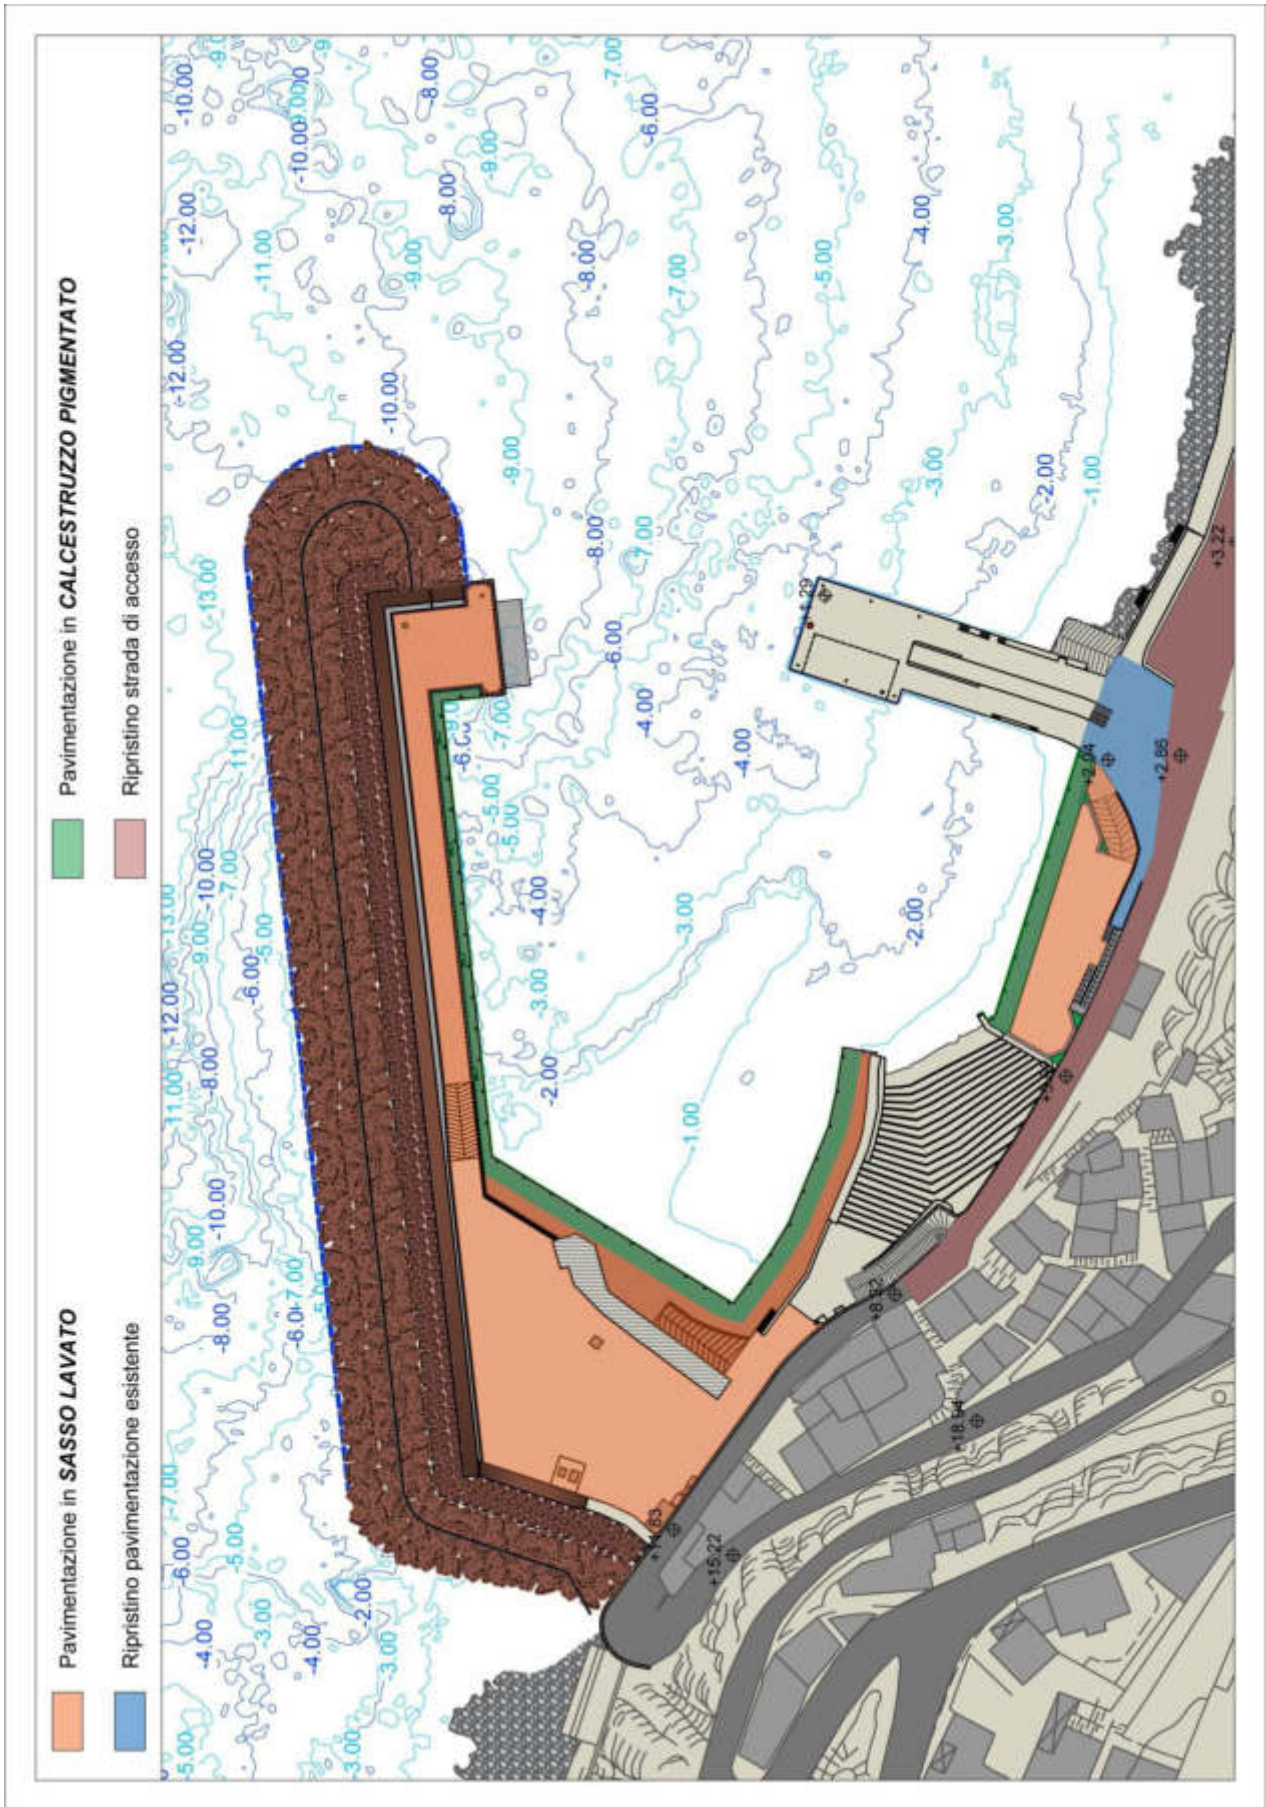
Planimetria con indicazione delle opere del progetto di riunione
